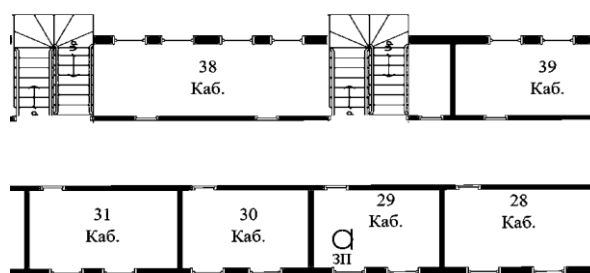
Фрагмент плану будівлі де розташовано джерело ЕМВ
